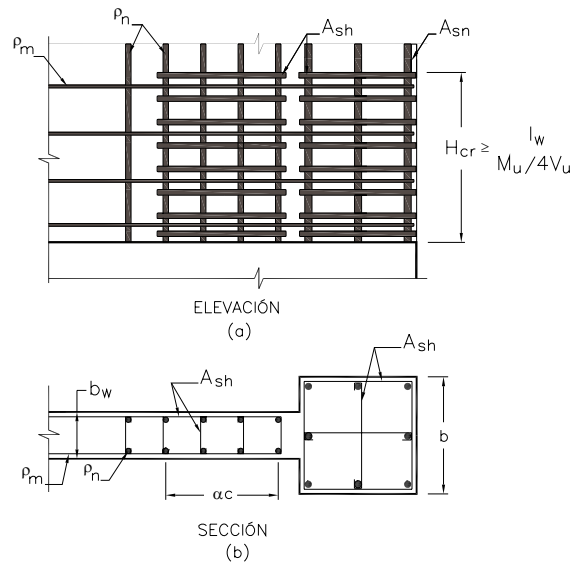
Cantidad de refuerzo confinante (adaptada de Paulay & Priestley, 1992)
